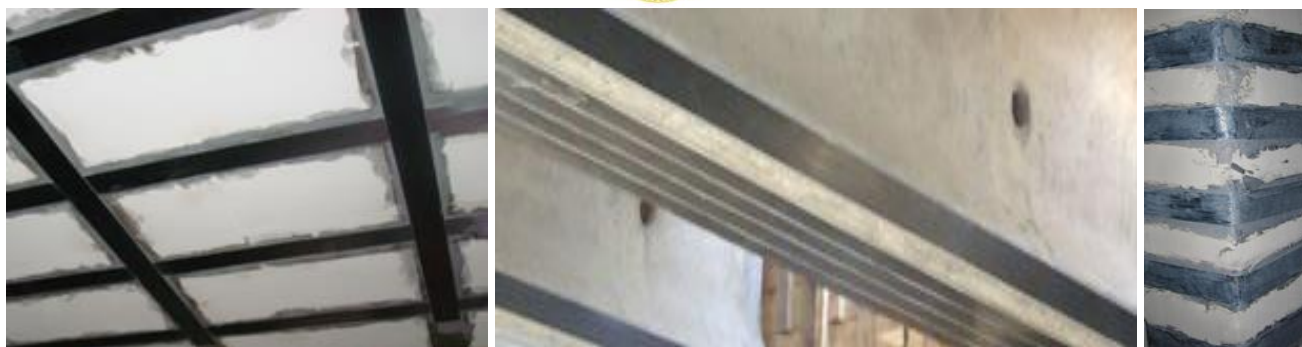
Усиление элемента железобетонной конструкции углепластиковыми ламелями
